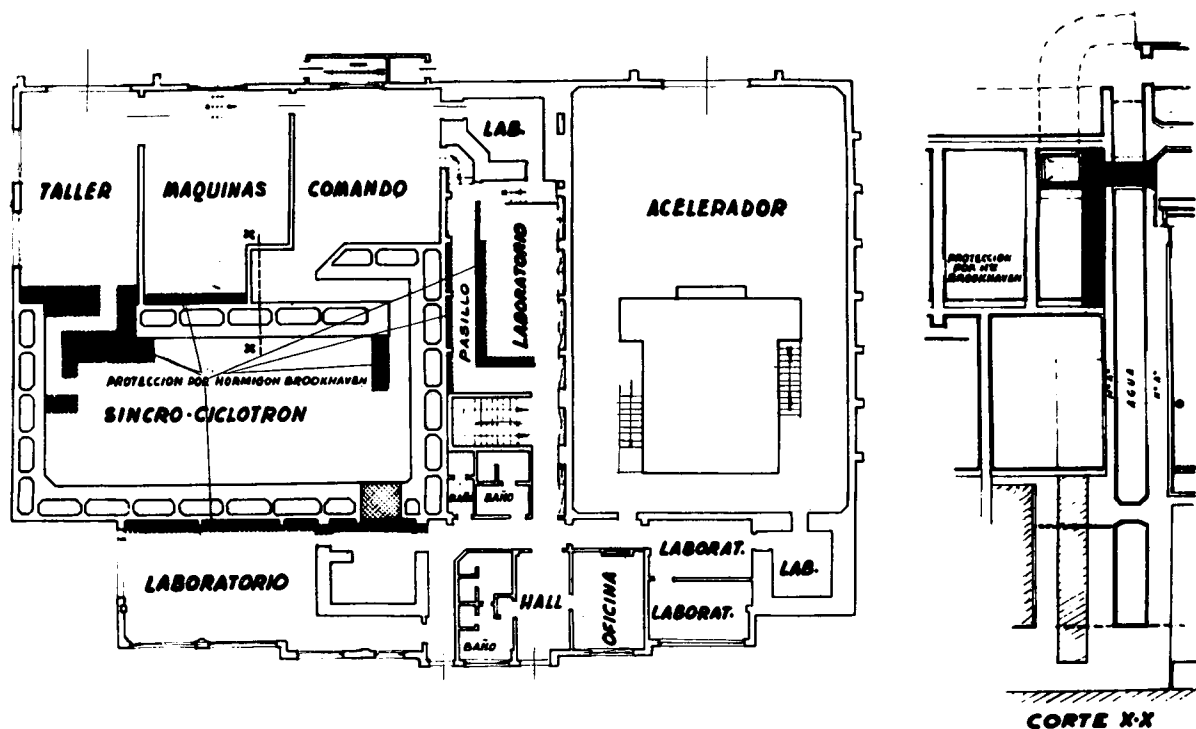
Planta y corte del recinto de la máquina. Las zonas rayadas indican el blindaje adicional en concreto Brookhaven.
